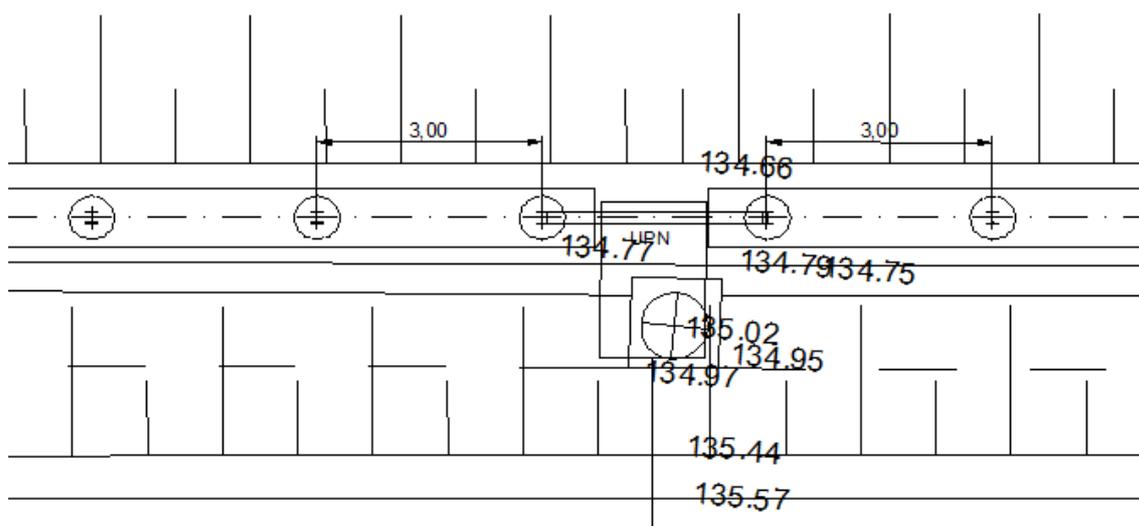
risoluzione interferenza puntuale con UPN di collegamento fondazioni
